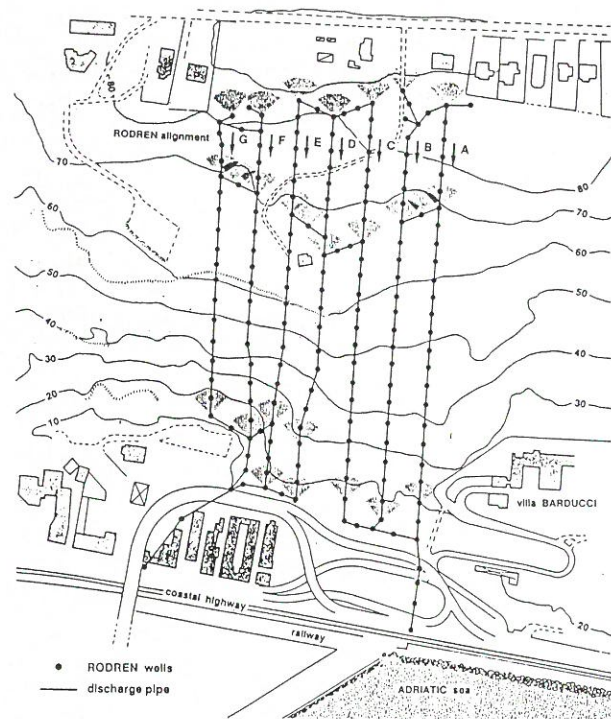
Planimetria dell'intervento di stabilizzazione della frana mediante pozzi drenanti collegati fra loro alla base.
